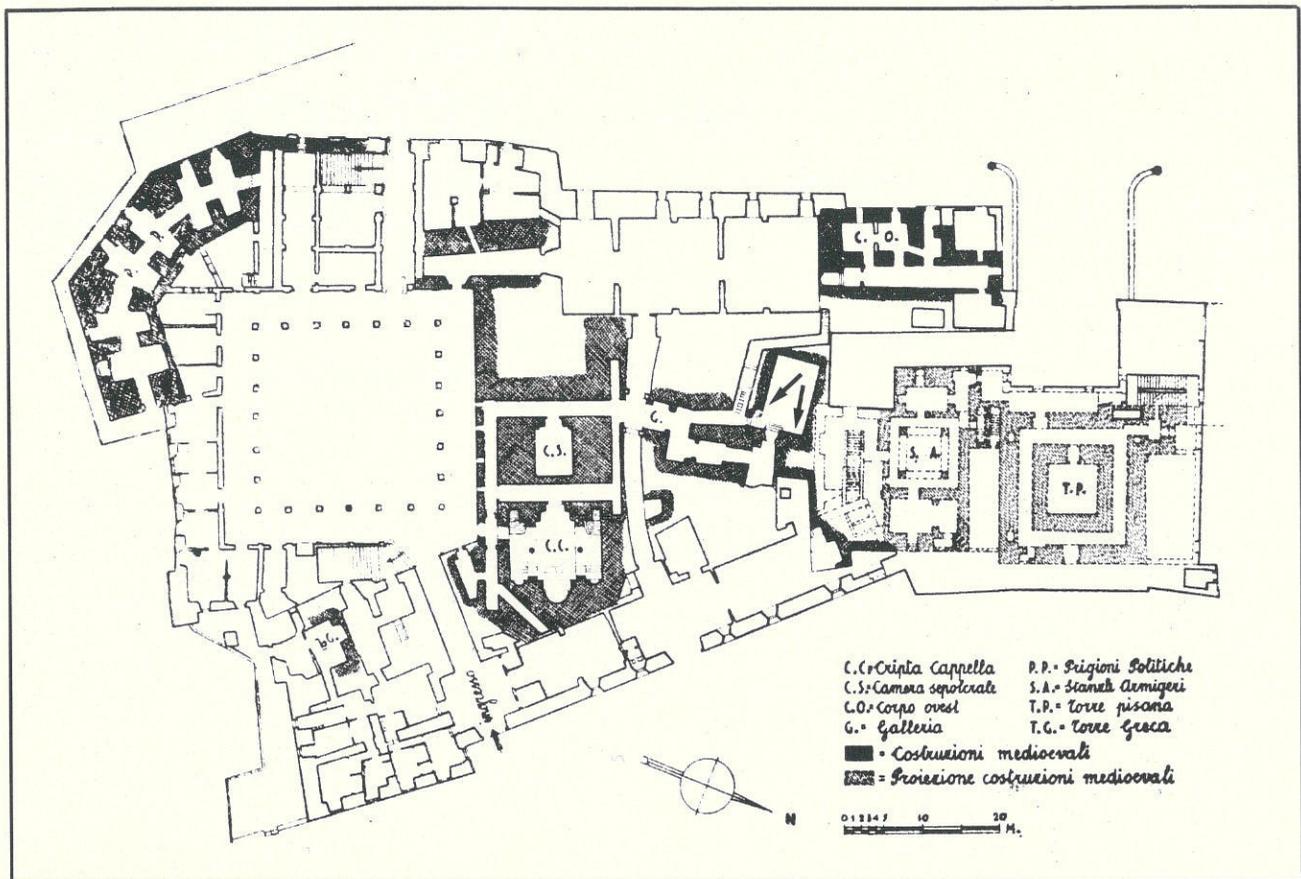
Pianta del piano terreno del Palazzo Reale di Palermo (Guilotto). Le frecce indicano l'ubicazione dei graffiti di alcune navi di età normanna.
